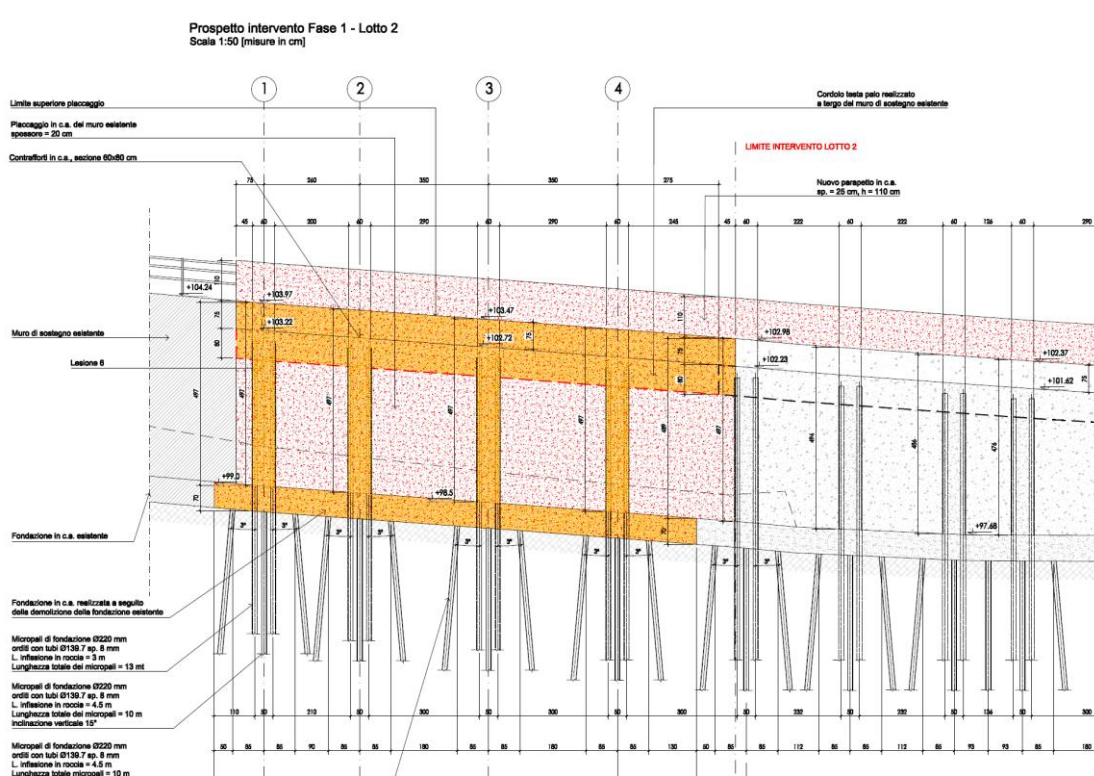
Prospetto raffronto intervento Lotto 2 – Fase 1 con prolungamento parapetto su Lotto 1
